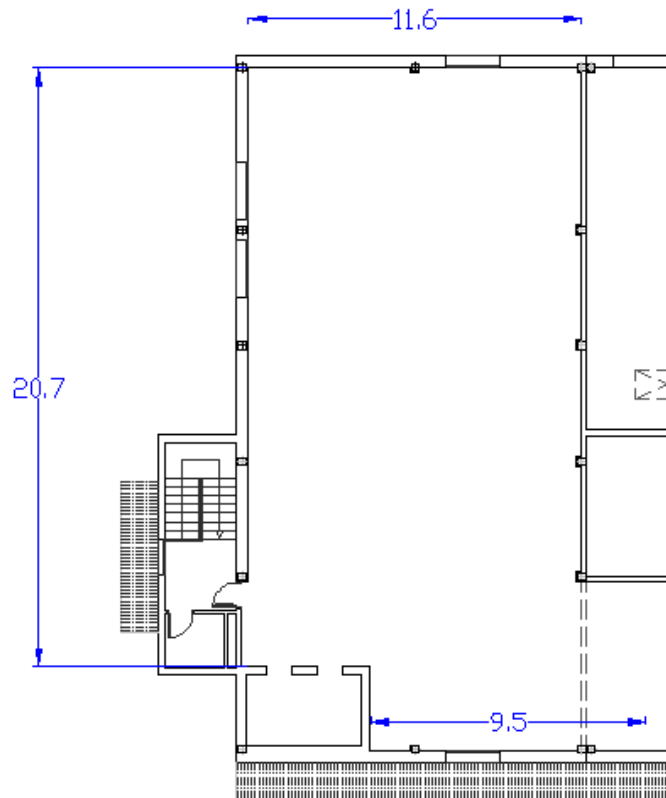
Vista en planta acotada del recinto para la instalación almacén aéreo.
